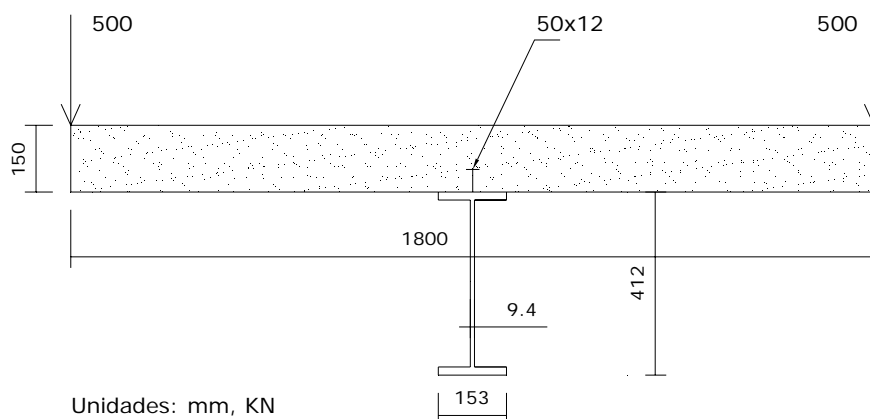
Seção transversal da viga mista e forças aplicadas num extremo
